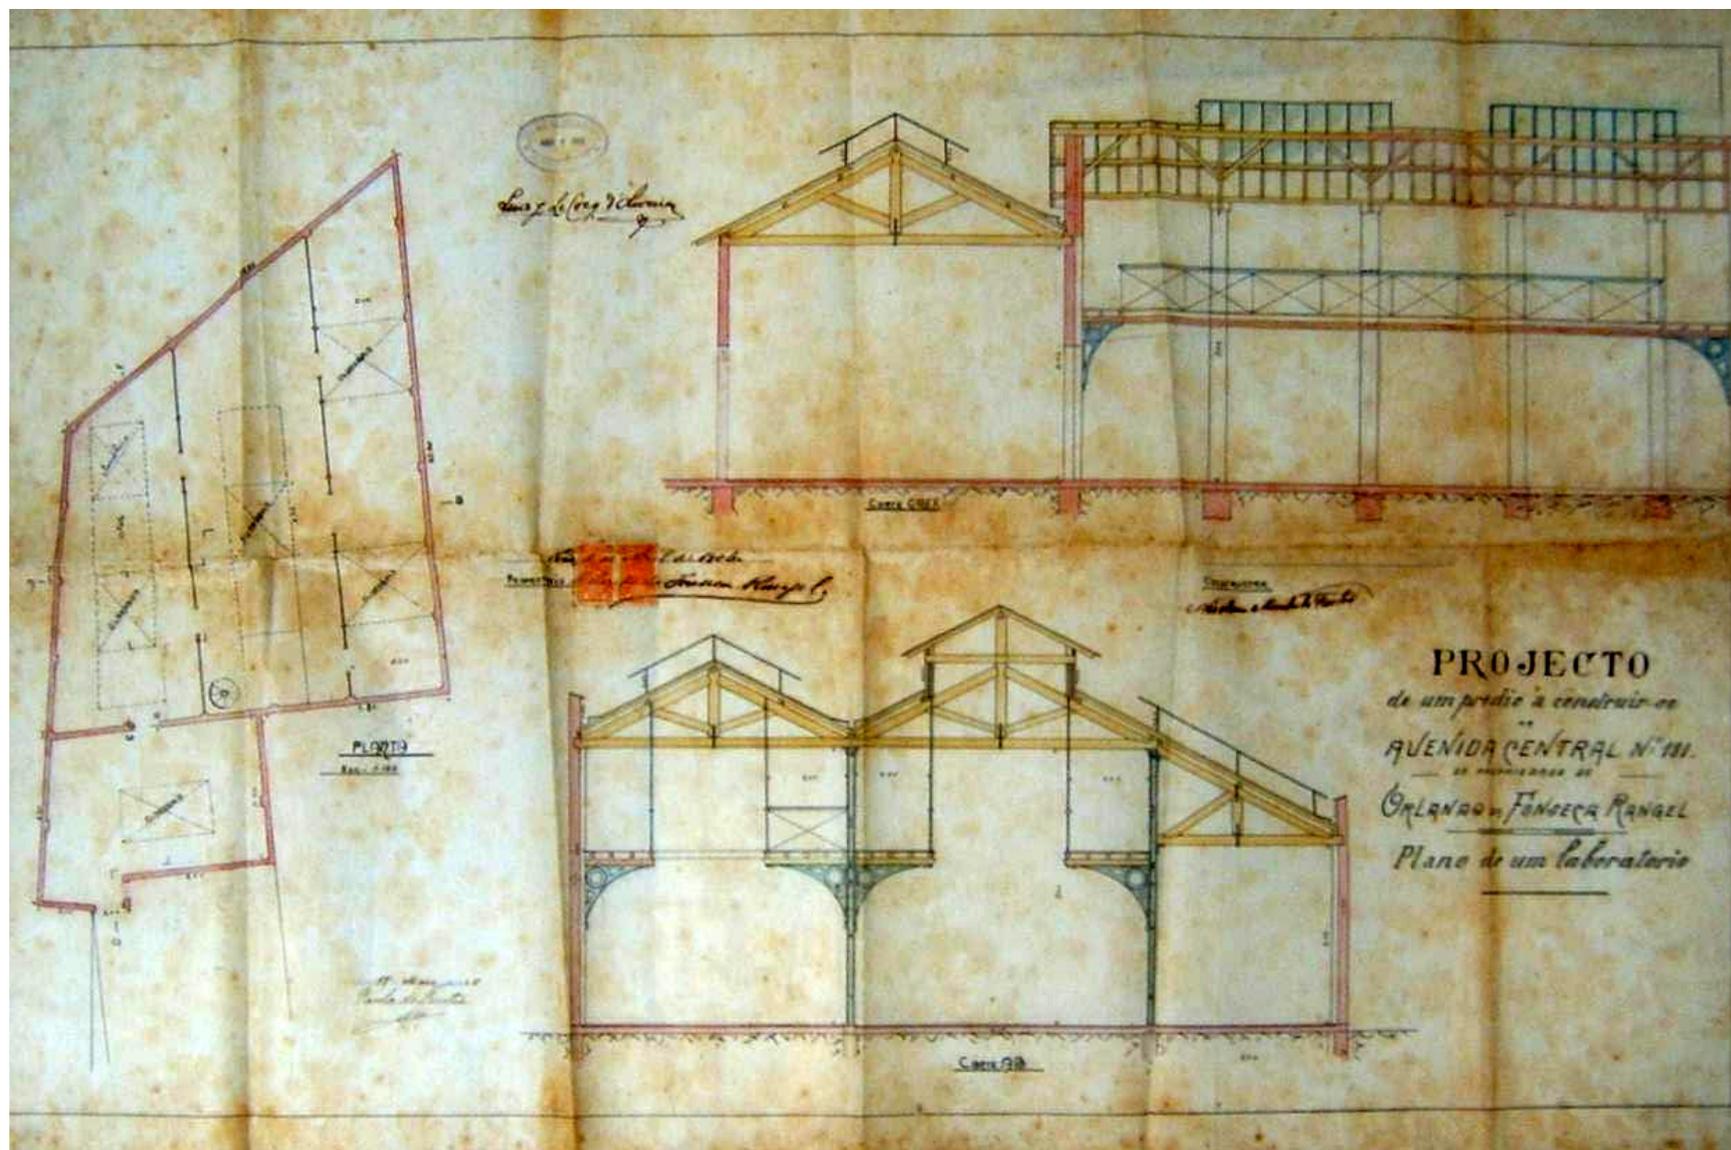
Planta baixa do prédio nº. 181, referente à área posterior do terreno. A ocupação é diferente daquela proposta no bloco frontal; apenas pavimento térreo, em forma de galpão com apoios em estrutura metálica e telhado em estrutura de madeira. Lê-se no título da prancha: Planta de um laboratório. Projeto de autoria de René Barba (Arquivo Nacional, fotografia da autora).
